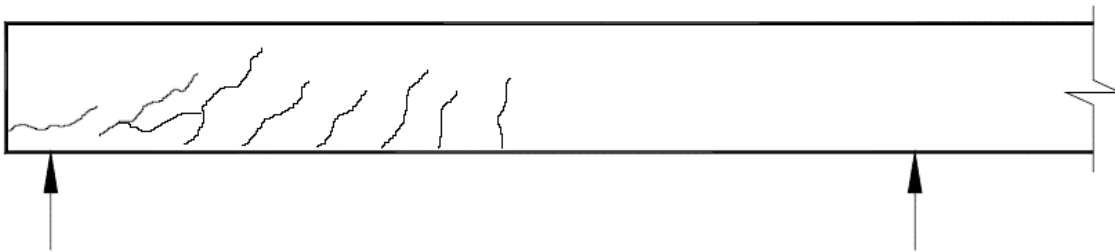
Fissuras de Retração e Temperatura
